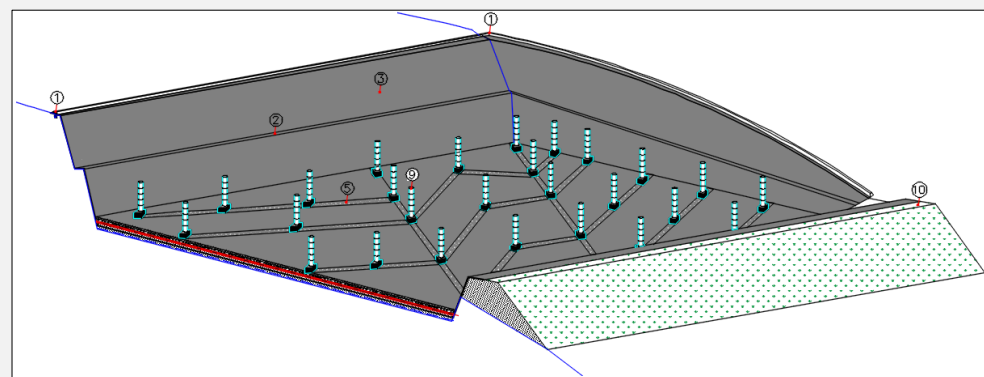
Detalhe esquemático da instalação da drenagem de gases.
